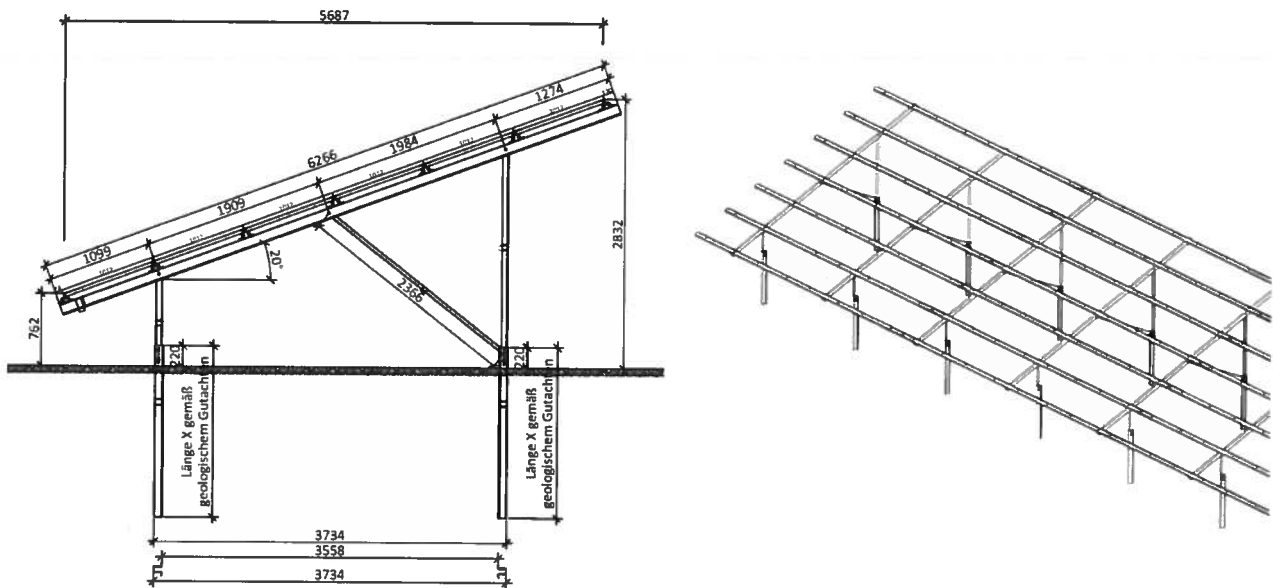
Skizze der Modulkonstruktion (Quelle: Planungsunterlagen)
